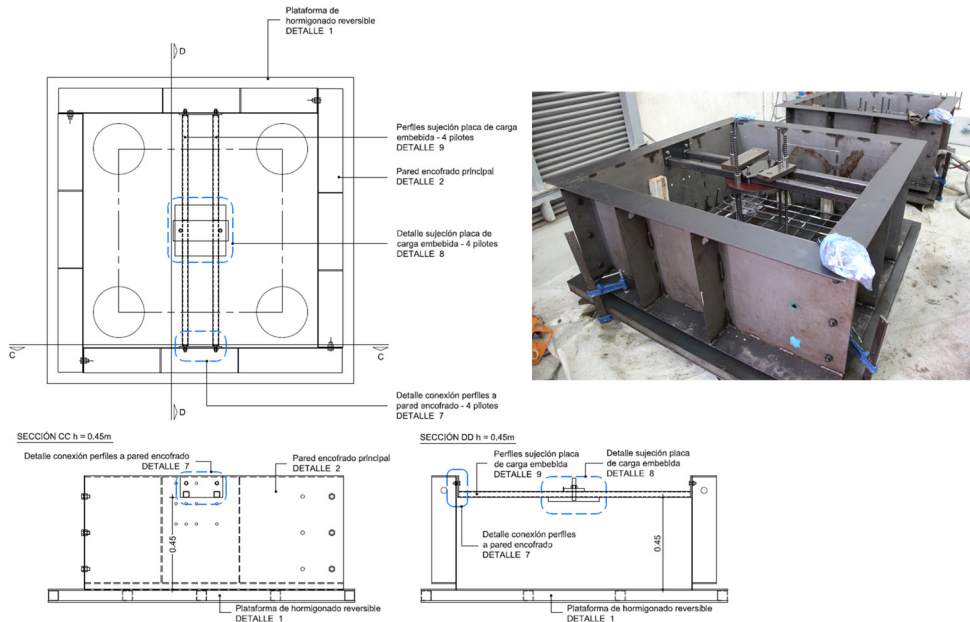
Plano e imagen real del encofrado para encofrados de cuatro pilotes
